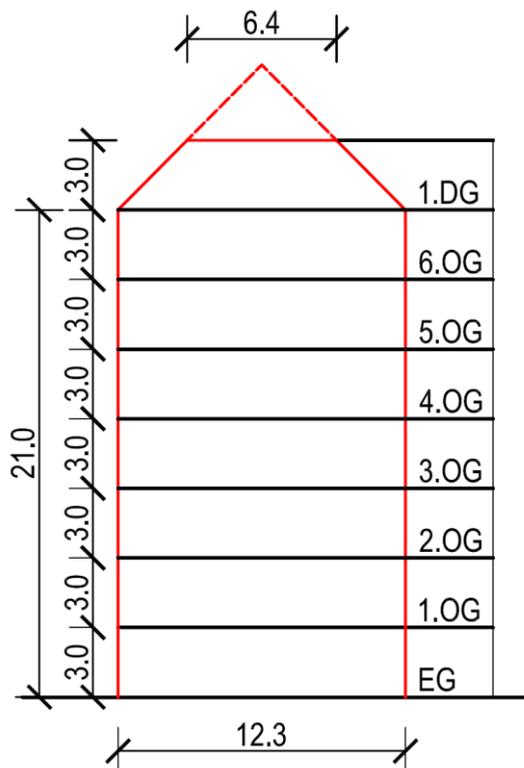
Skizze Schnitt An den Kohlrutschen 6-8; 1020 Wien
